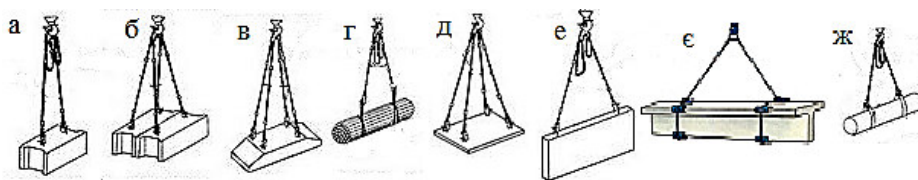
Схеми стропування вантажів: а, б – фундаментних блоків; в – фундаментних плит; г – труб малого діаметра; д – плит перекриття; е – стінових панелей; є – балок; ж – труб великого діаметра,
